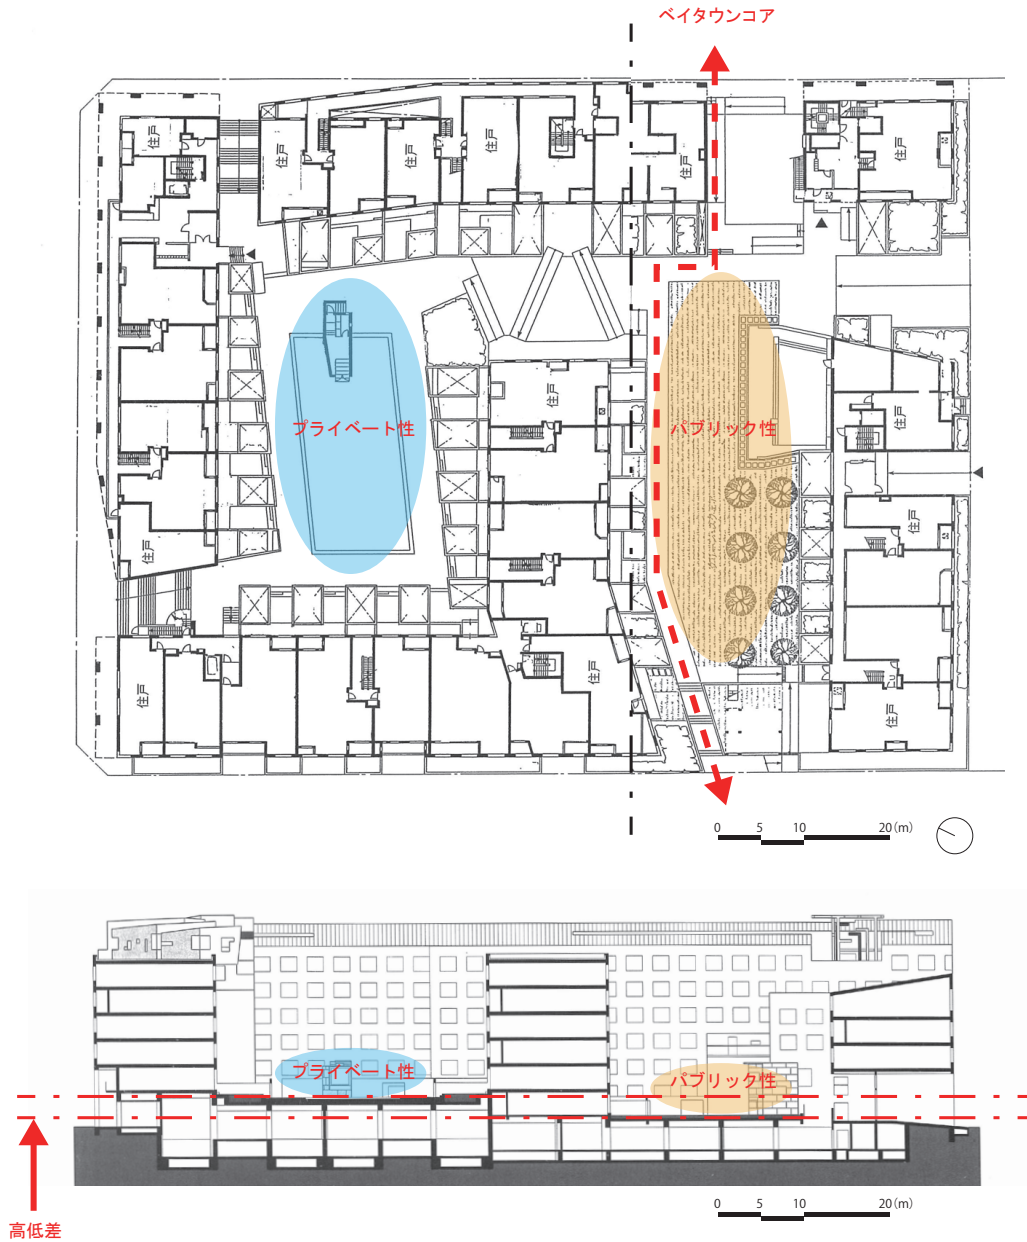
パティオス 11 番街平面図 (上図)・断面図 (下図)
